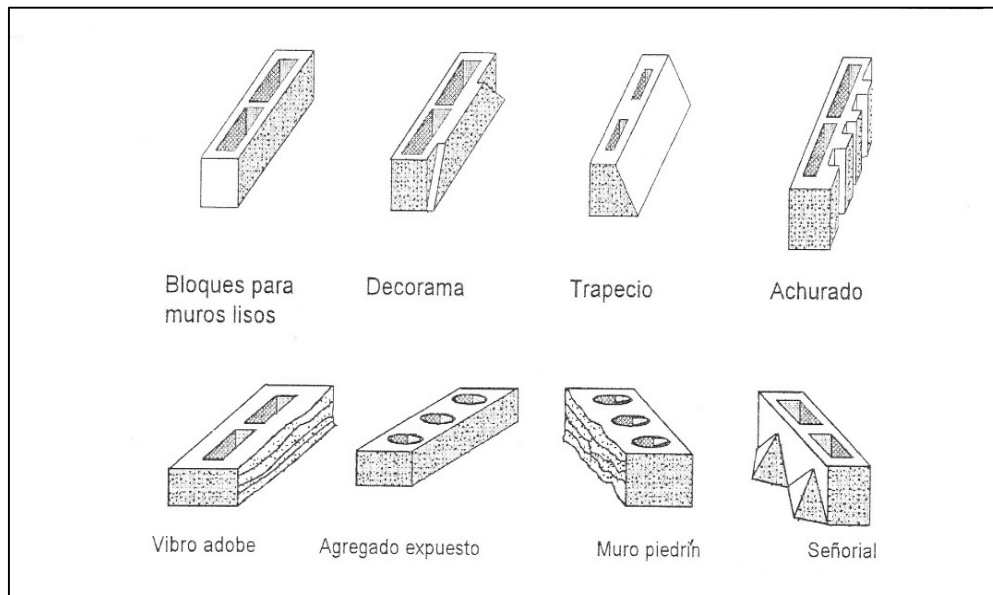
Piezas en relieve para mampostería. (Fuente: Sociedad Mexicana de Ingeniería Estructural, A.C.; 1999: 21)
